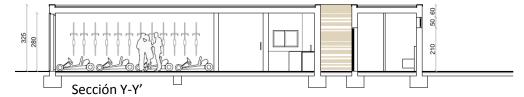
Sección Y-Y' de planta arquitectónica. http://galerias.villadelprado.org/pliegos/edvial/Planosdereferencia.pdf. Marzo 2012
